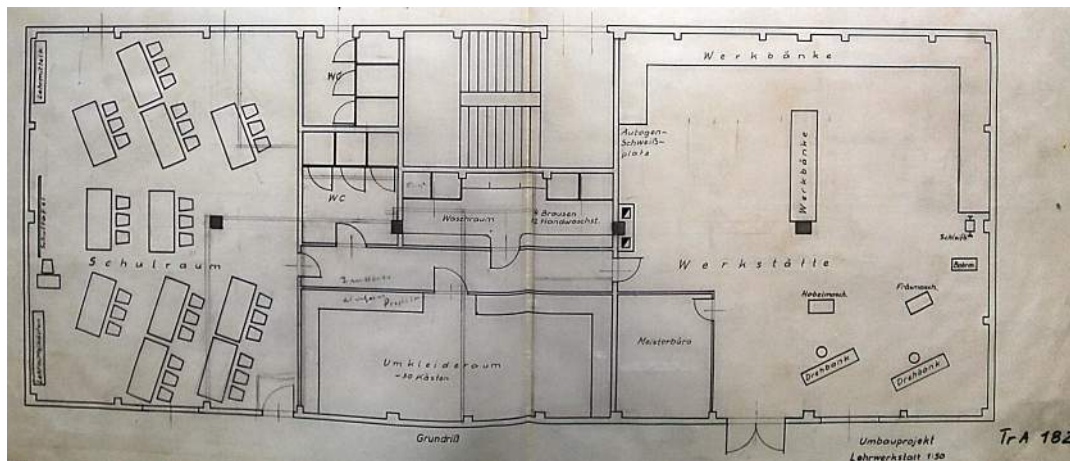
Ausschnitt aus dem Umbauplan vom 15.1.1973
